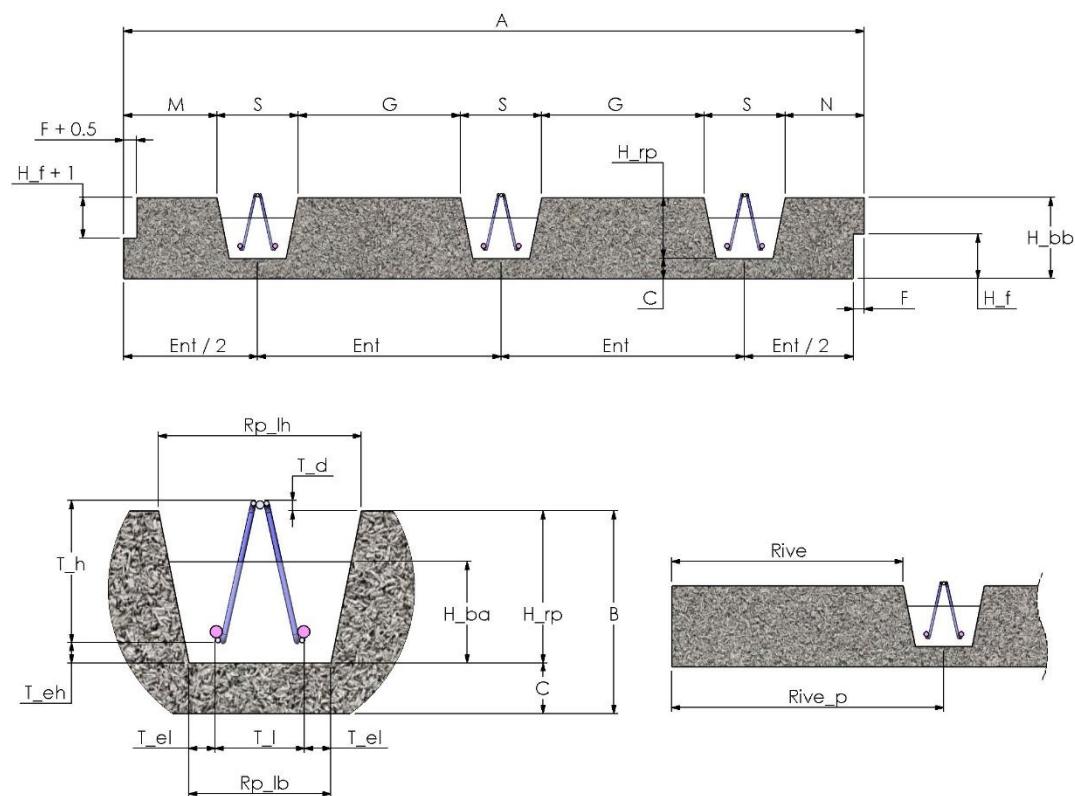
Cotation des Prédalles DS1 – Coupe transversale
